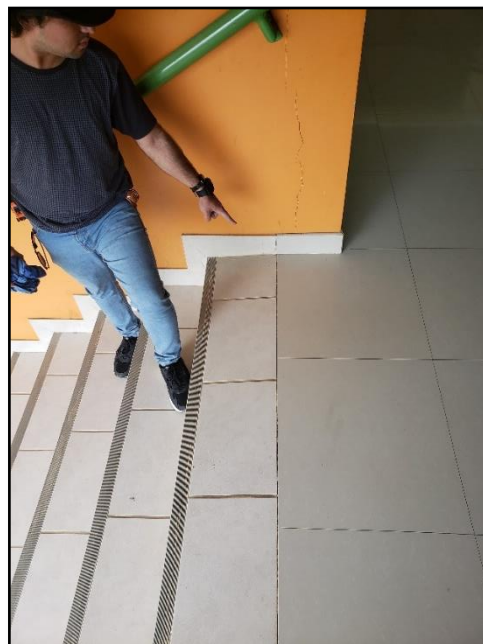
Presencia de fisuras en las paredes justo en los bloques de la escalera de acceso y los ambientes de Administrativo 02 donde no existe junta de separación de la Facultad de Ingeniería Agroindustrial (Fuente: Elaboración propia)
